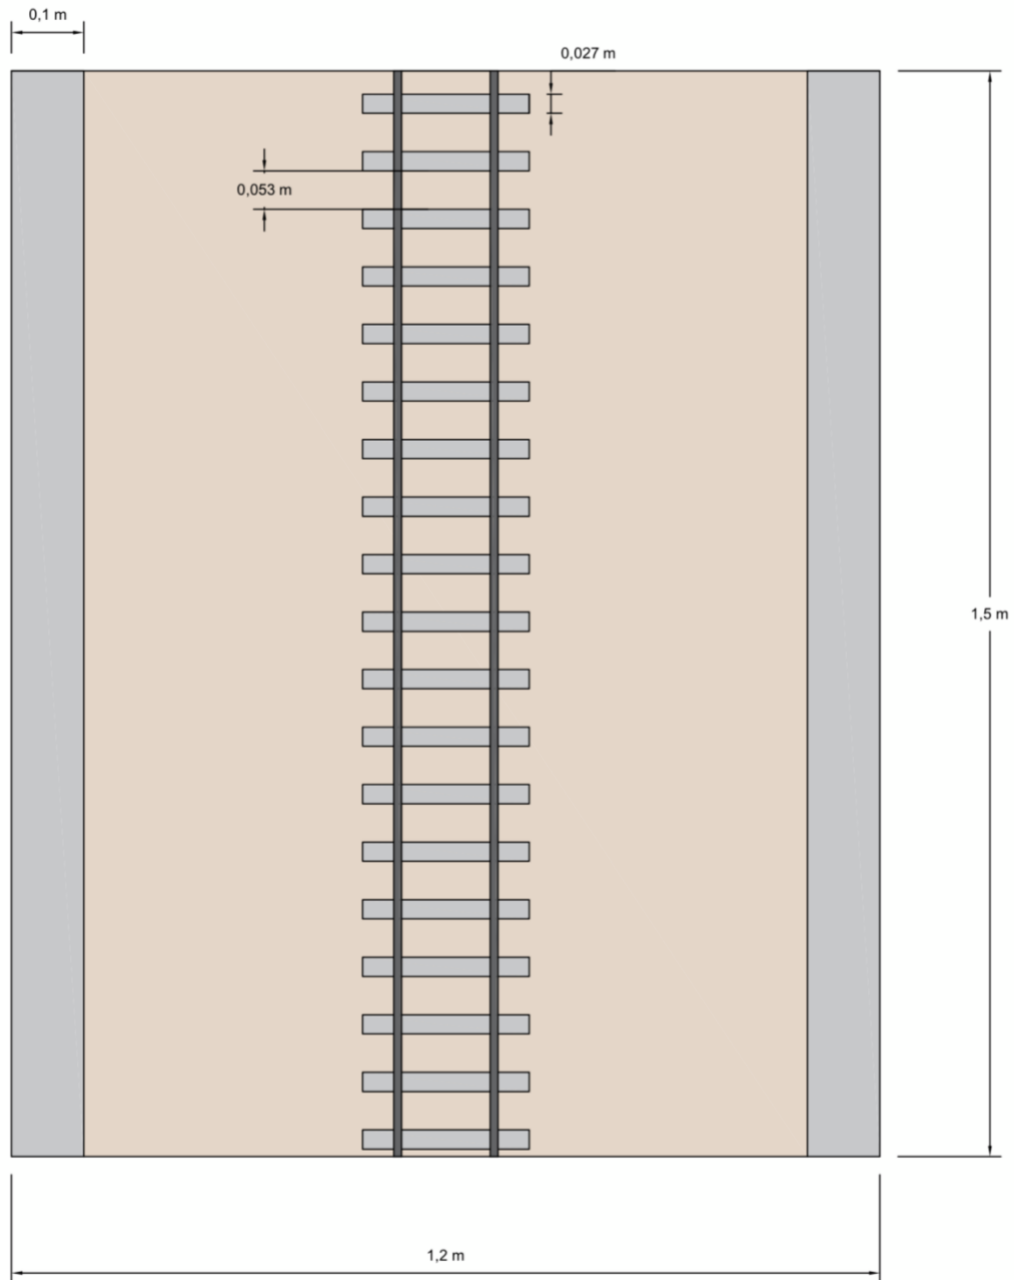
Cajón en la postura que da soporte a la vía en placa. Plano Anexo N° 8.
